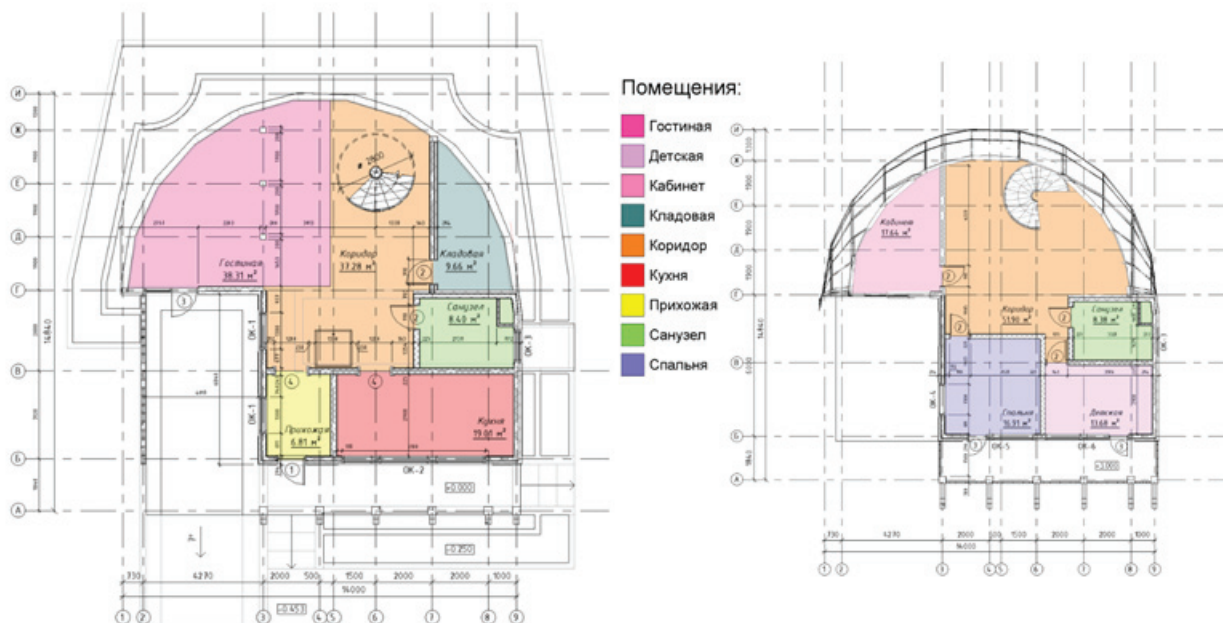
План этажей активного коттеджа: а) план первого этажа; б) план второго этажа
